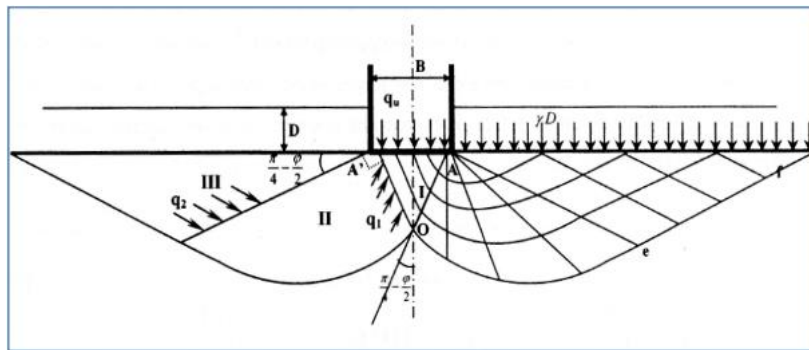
Mécanisme de rupture d'une fondation de base lisse (Prandtl (1920))
